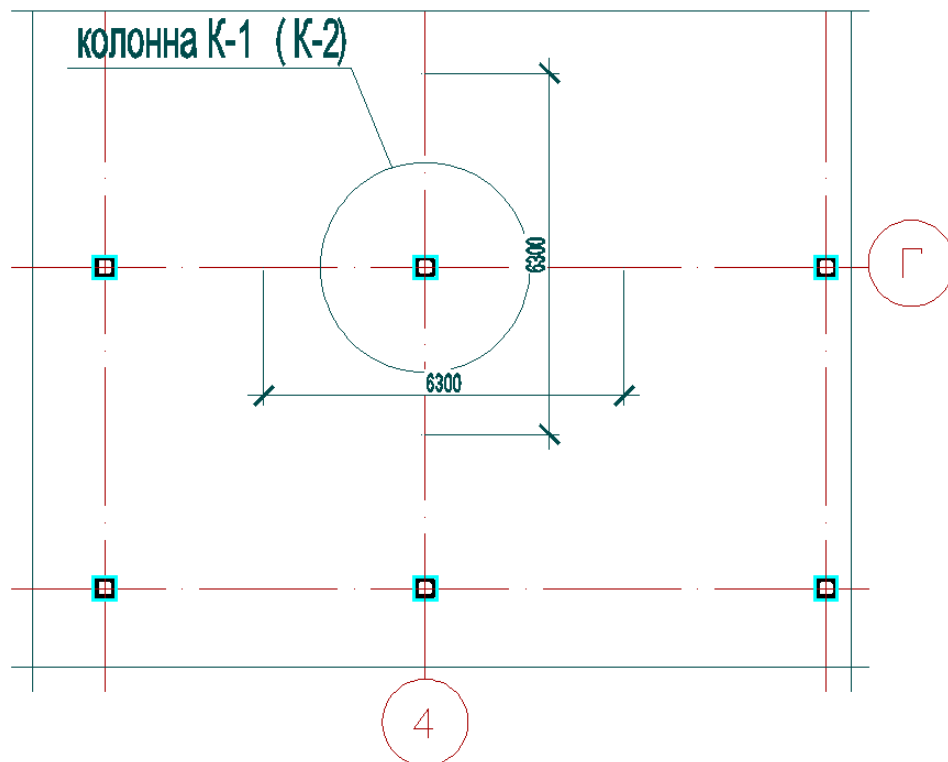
Грузовая площадь для расчета монолитной колонны
